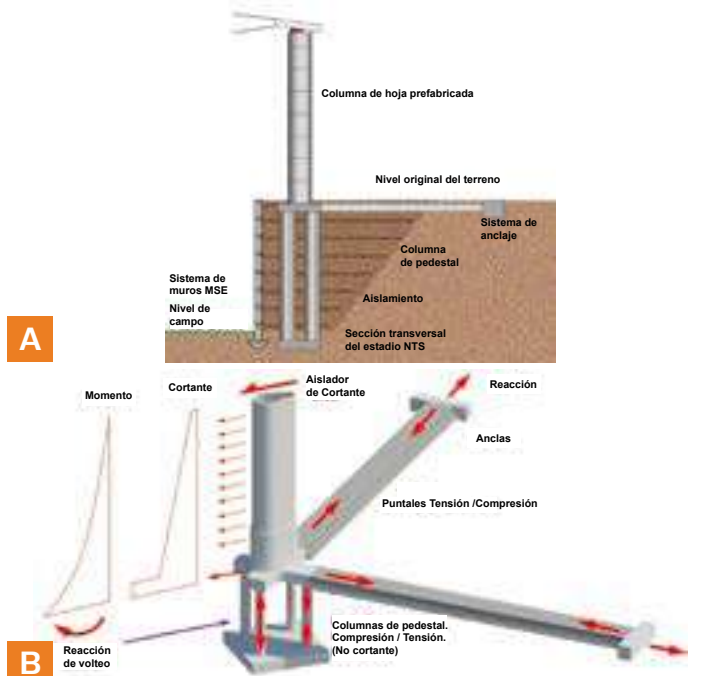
Esquemas del MSE y las columnas de hoja de la estructura de soporte del techo: (a) Las columnas de hoja están soportadas por columnas de pedestal, que están aisladas del relleno del MSE. (b) Un sistema de puntal y anclaje transfiere las fuerzas cortantes desde el techo y las columnas de hoja hacia el suelo más allá del relleno.
